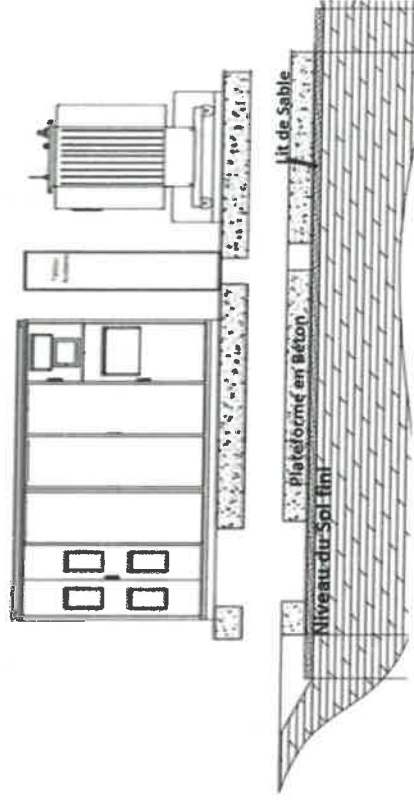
Schéma de principe d'installation d'un poste type « Skid » (Plan RES)
